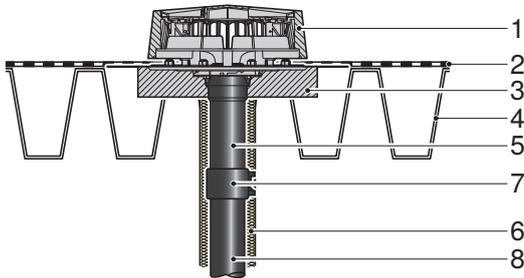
Монтаж на неизолированной легкой кровле с кровельным покрытием
